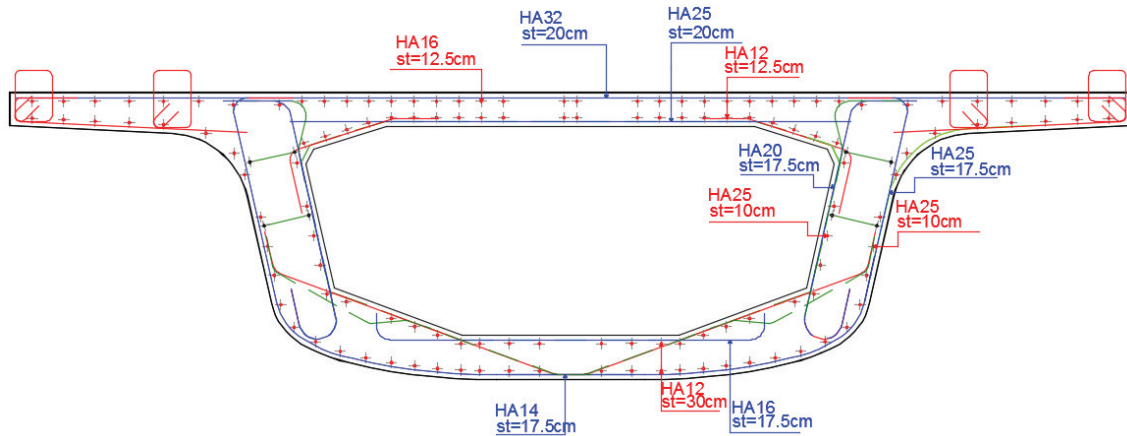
Schéma du ferrailage passif du voussoir courant.
